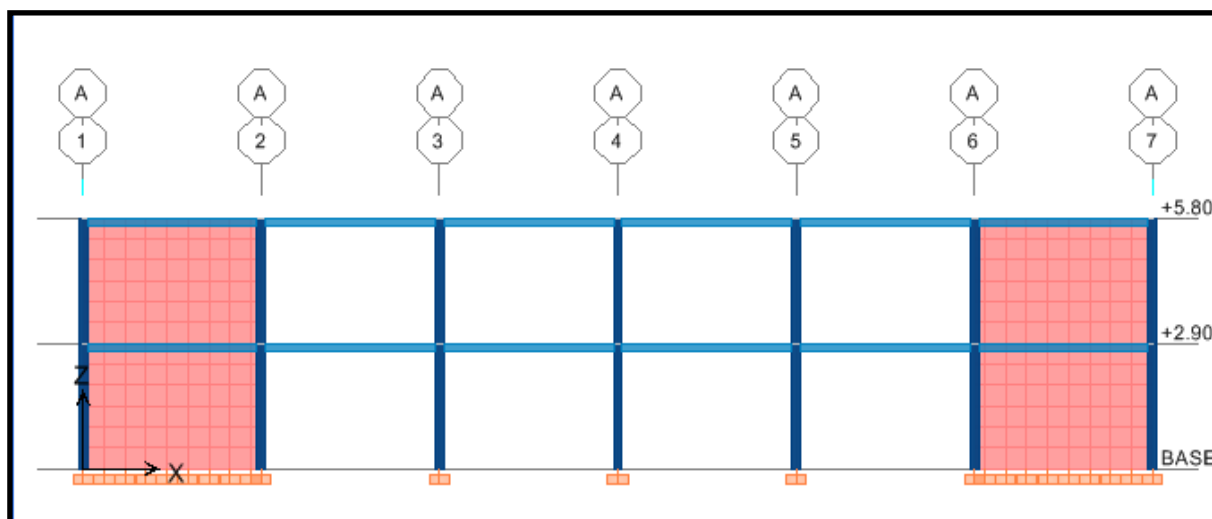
Alzado de la Propuesta de Reforzamiento en la dirección corta “x” de la edificación
